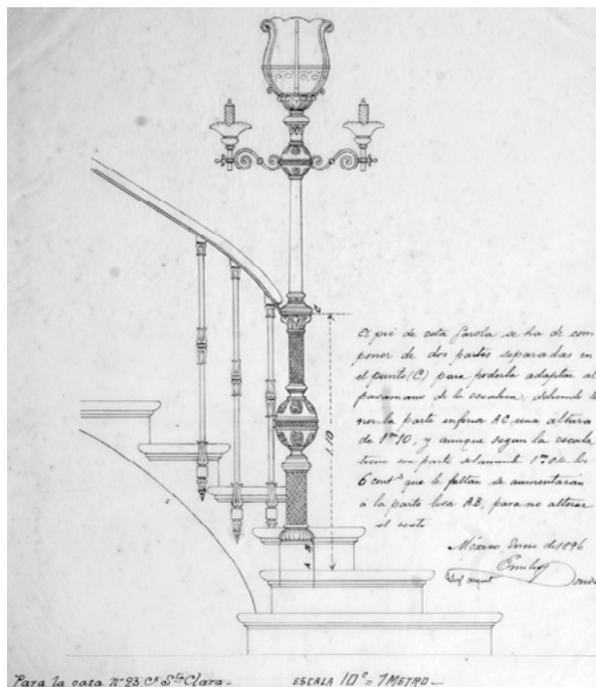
AHE, CNVHNAH, "Casa de Santa Clara no. 23", leg. I, caja 2, plano 154.
